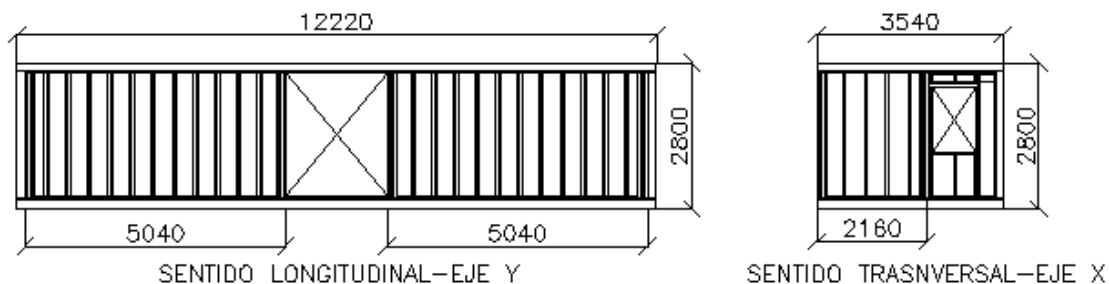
Detalle de dimensiones y elevaciones por módulo prefabricado
